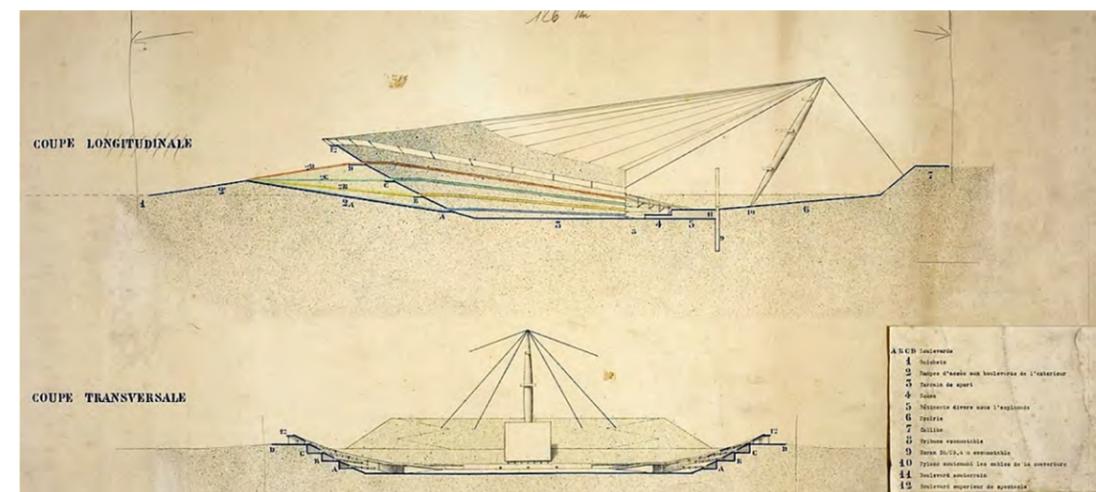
FLC 3447: Secciones longitudinal y transversal planas del Estadio.
